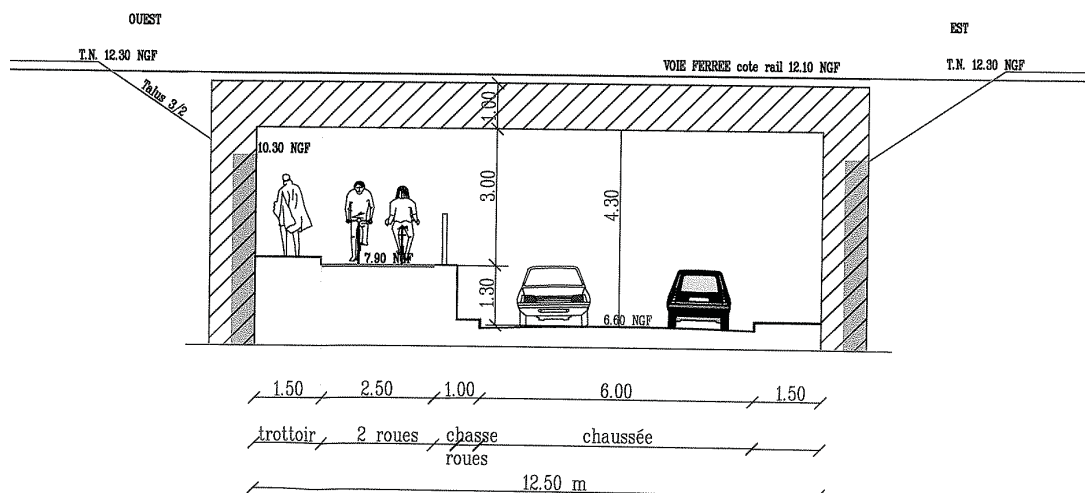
Profil en travers – ouvrage inférieur de la bifurcation de Beyreman
